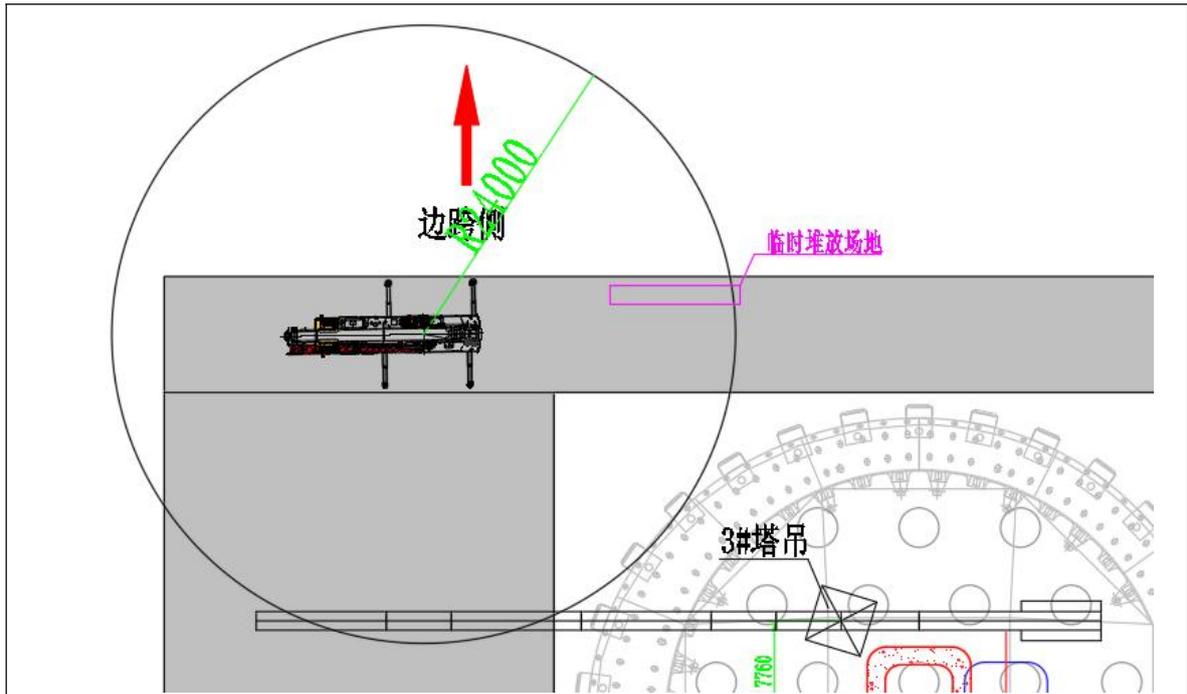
3#塔吊其余起重臂吊装平面示意图
